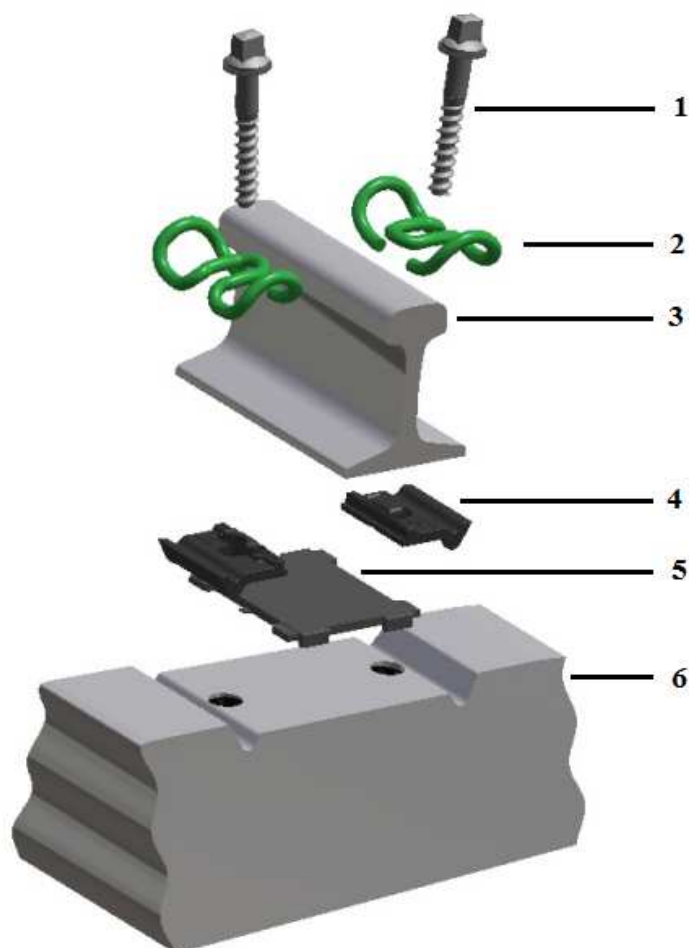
Конструктивное решение рельсового крепления Фоссло
